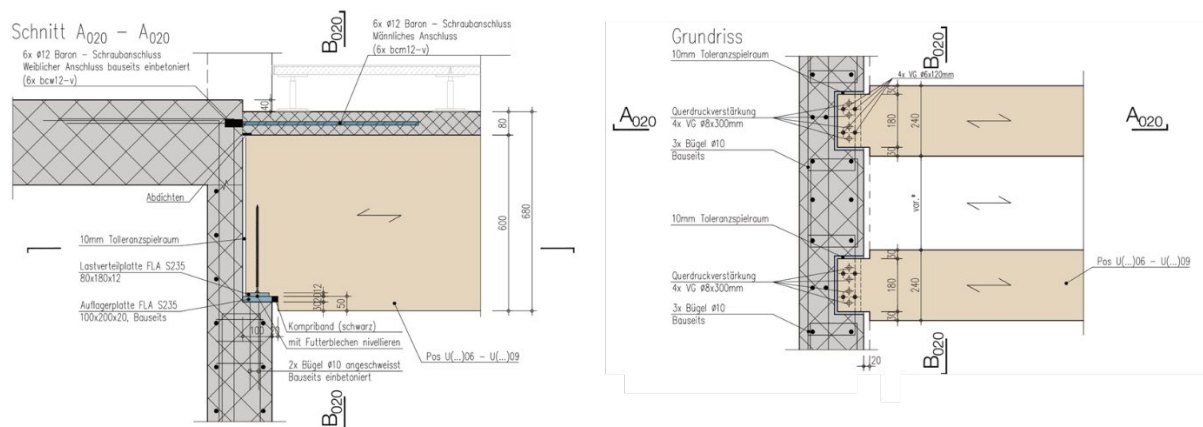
Anschluss Zangenträger an Sichtbetonwand
